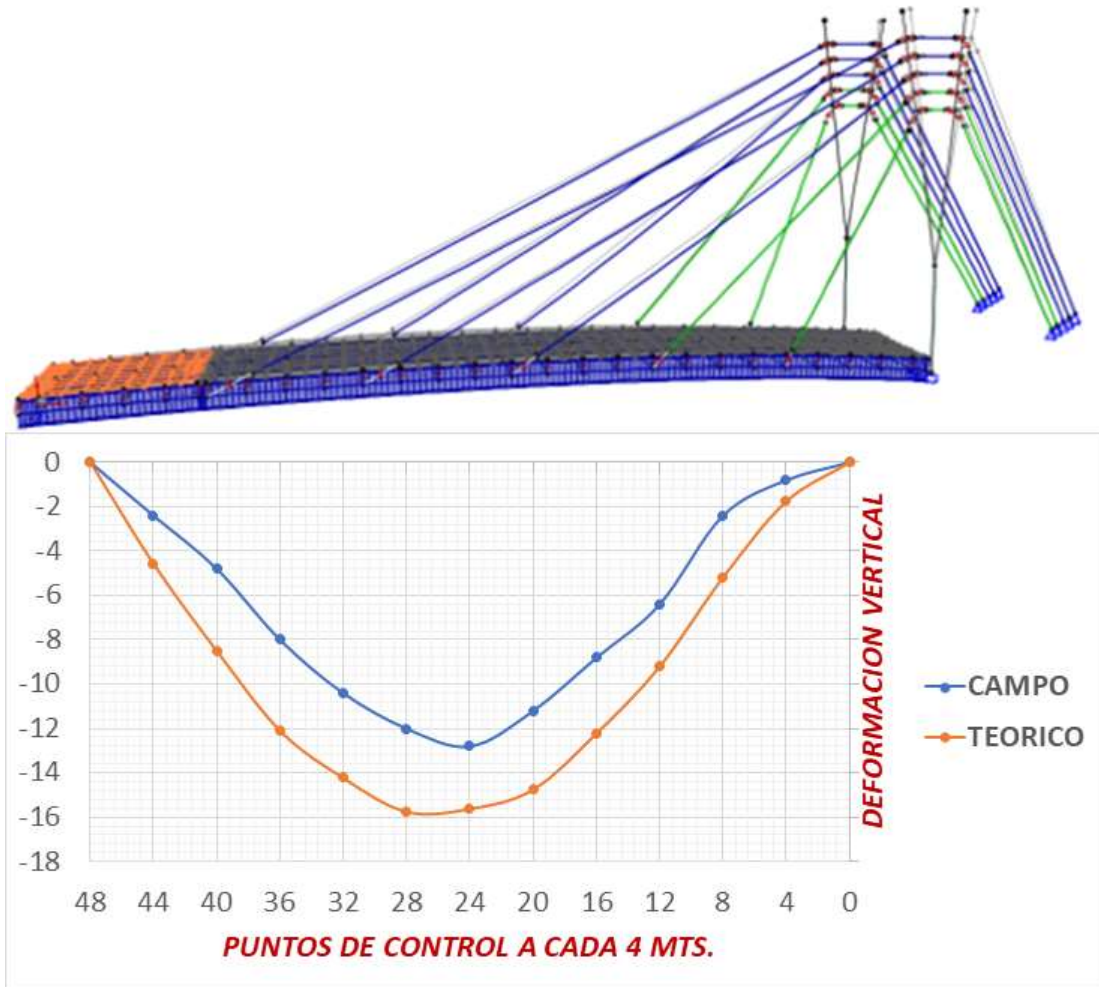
Control en Campo - Colocacion del Quinto Paño de Losa de Concreto
